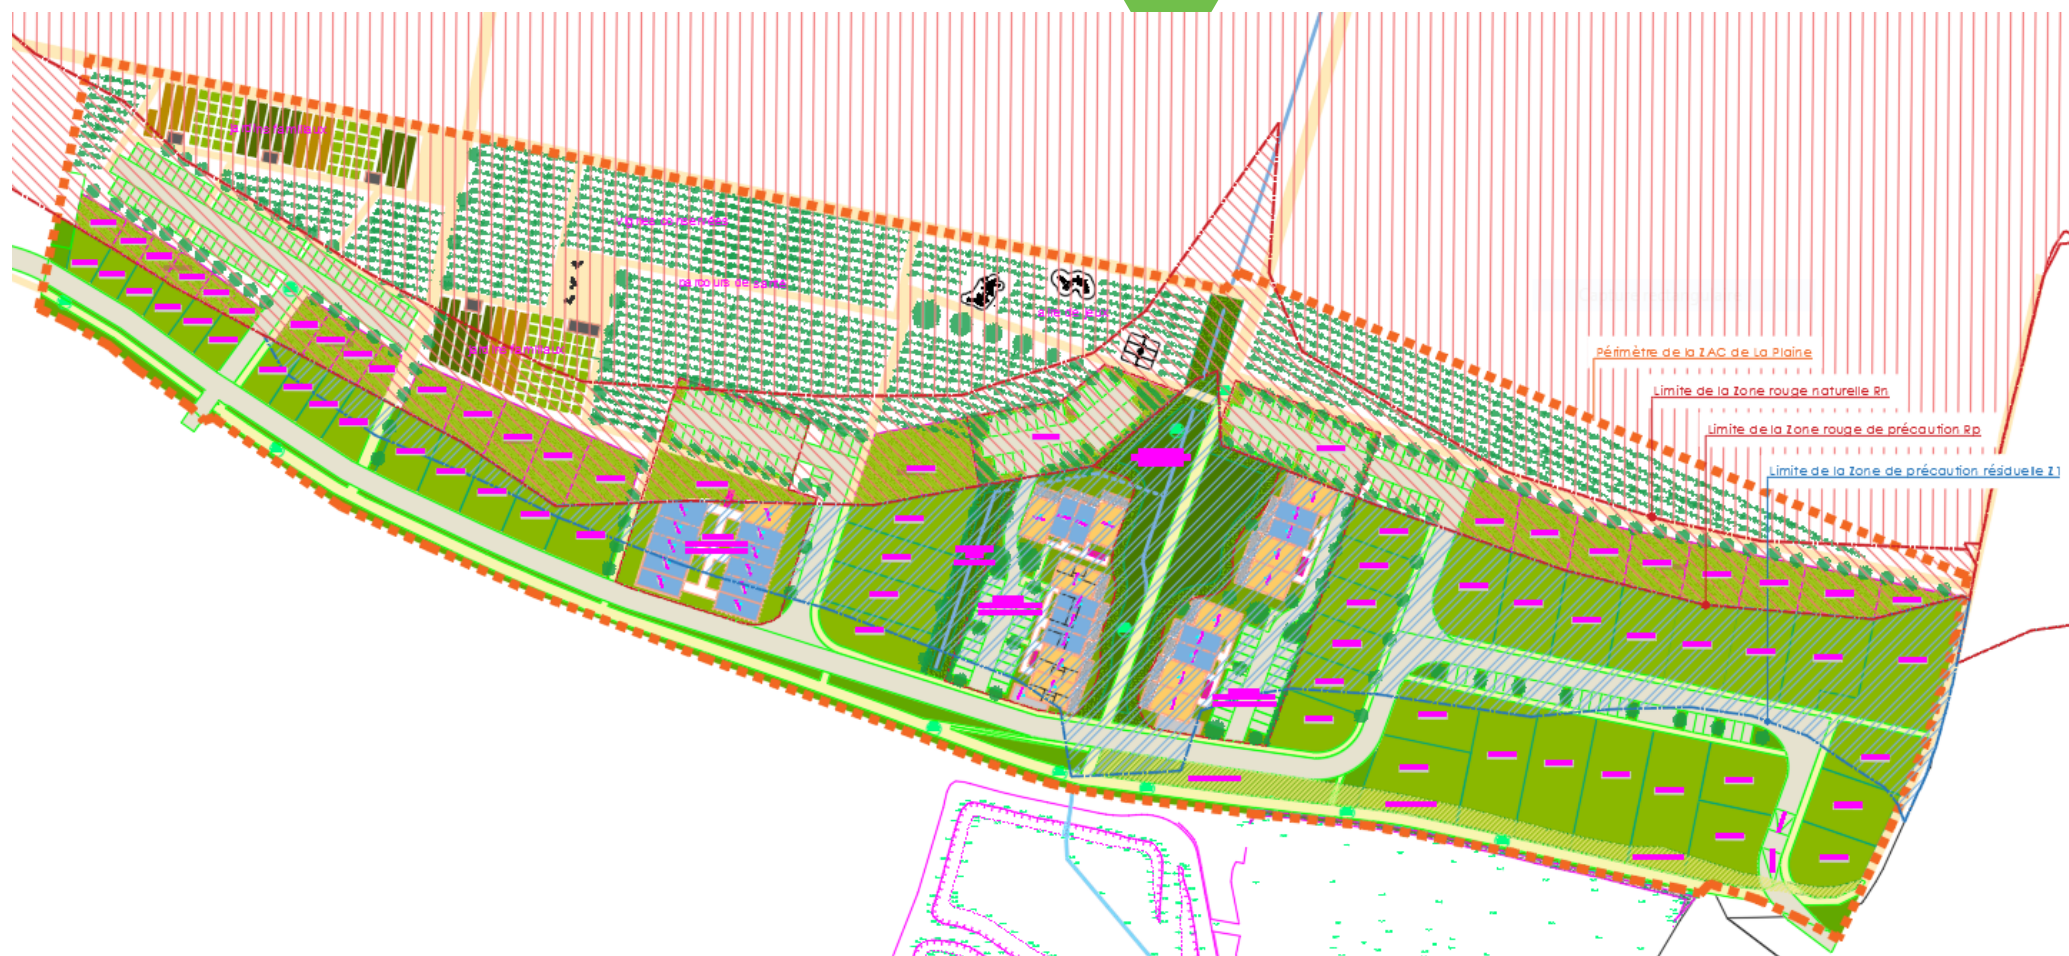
Projection du plan de masse sur zonage réglementaire PPR
